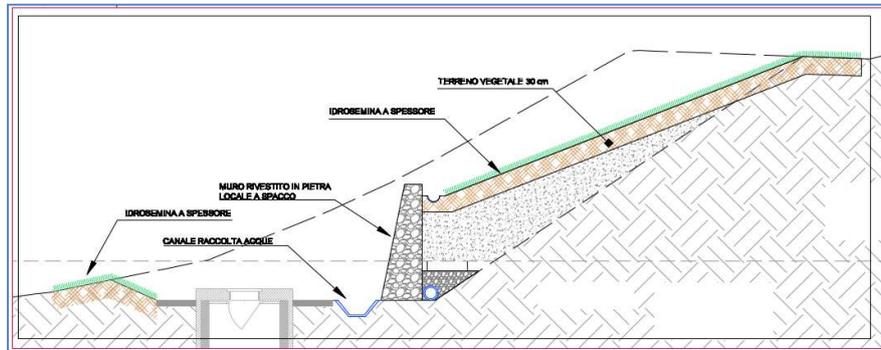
Inerbimento area lavorazione "pozzi drenanti" - sezione
